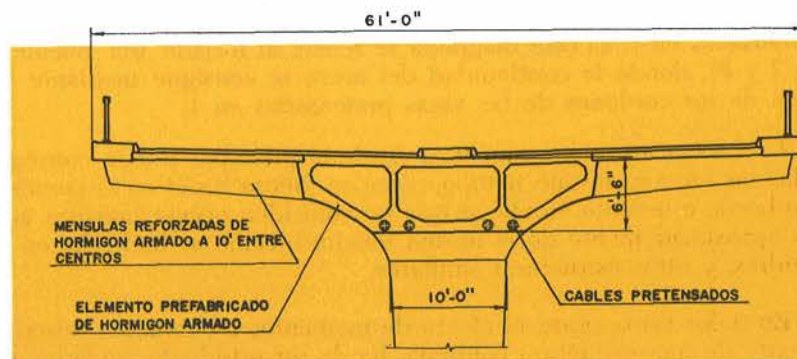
Viaducto de Hammersmith, Londres, de 140 pies de luz. Sección transversal.
